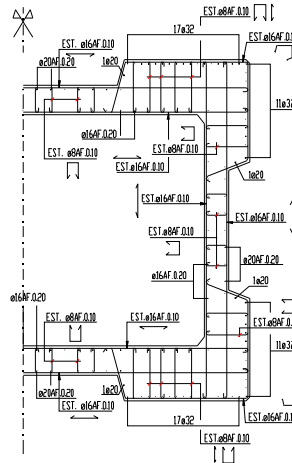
Armadura longitudinal e transversal dos pilares P1 e P9.
